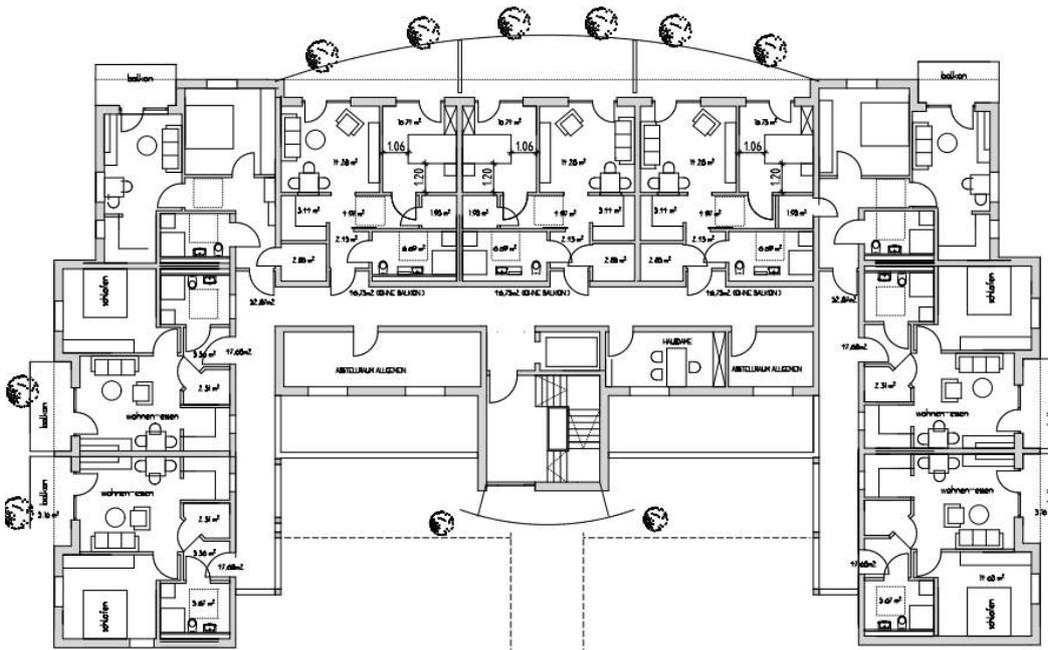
Betreutes Wohnen Grundriss OG
